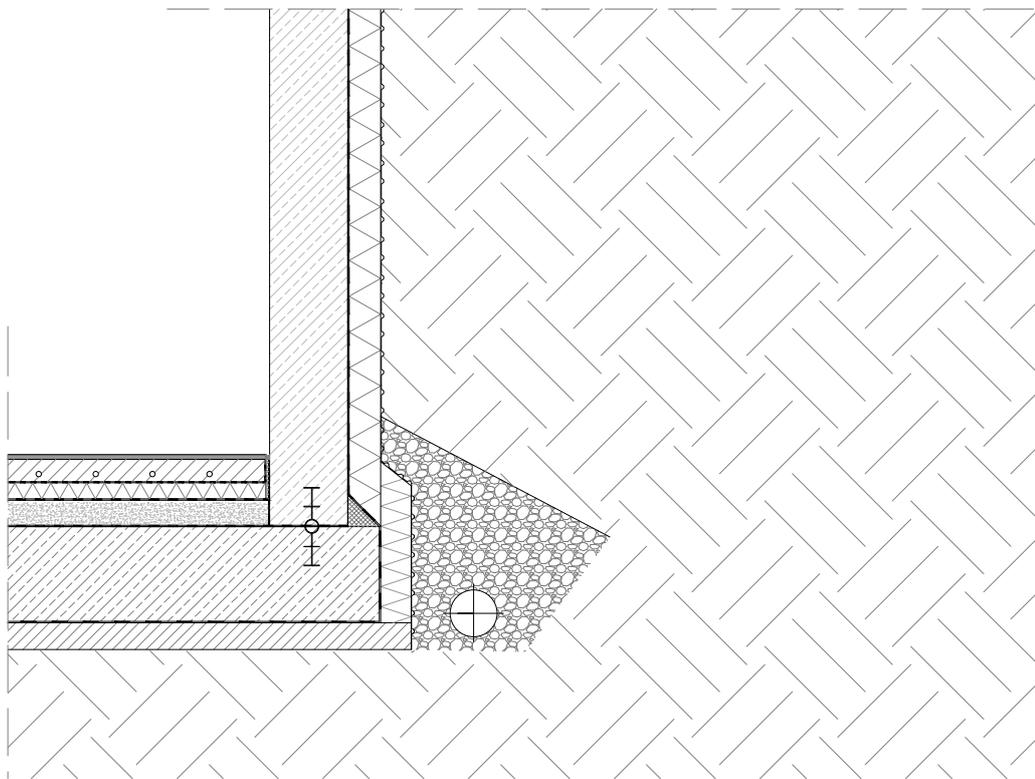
Detaillierte Fassadenschnitt M:1:25
